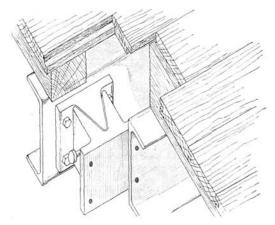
Detalle de la conexión del suelo de dos secciónes. (Aluminium Foundation)
